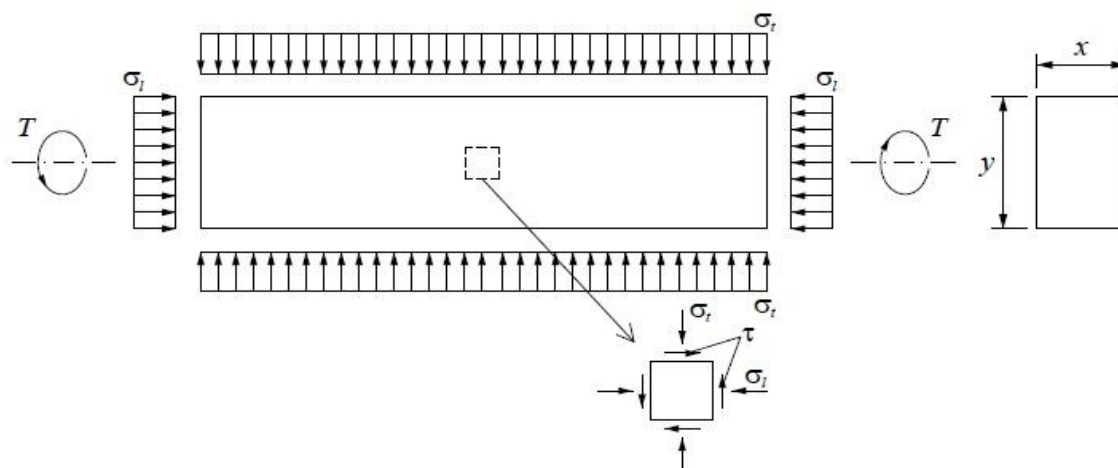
Estado de tensão numa viga sujeita à torção e a um pré-esforço longitudinal e transversal [10]
